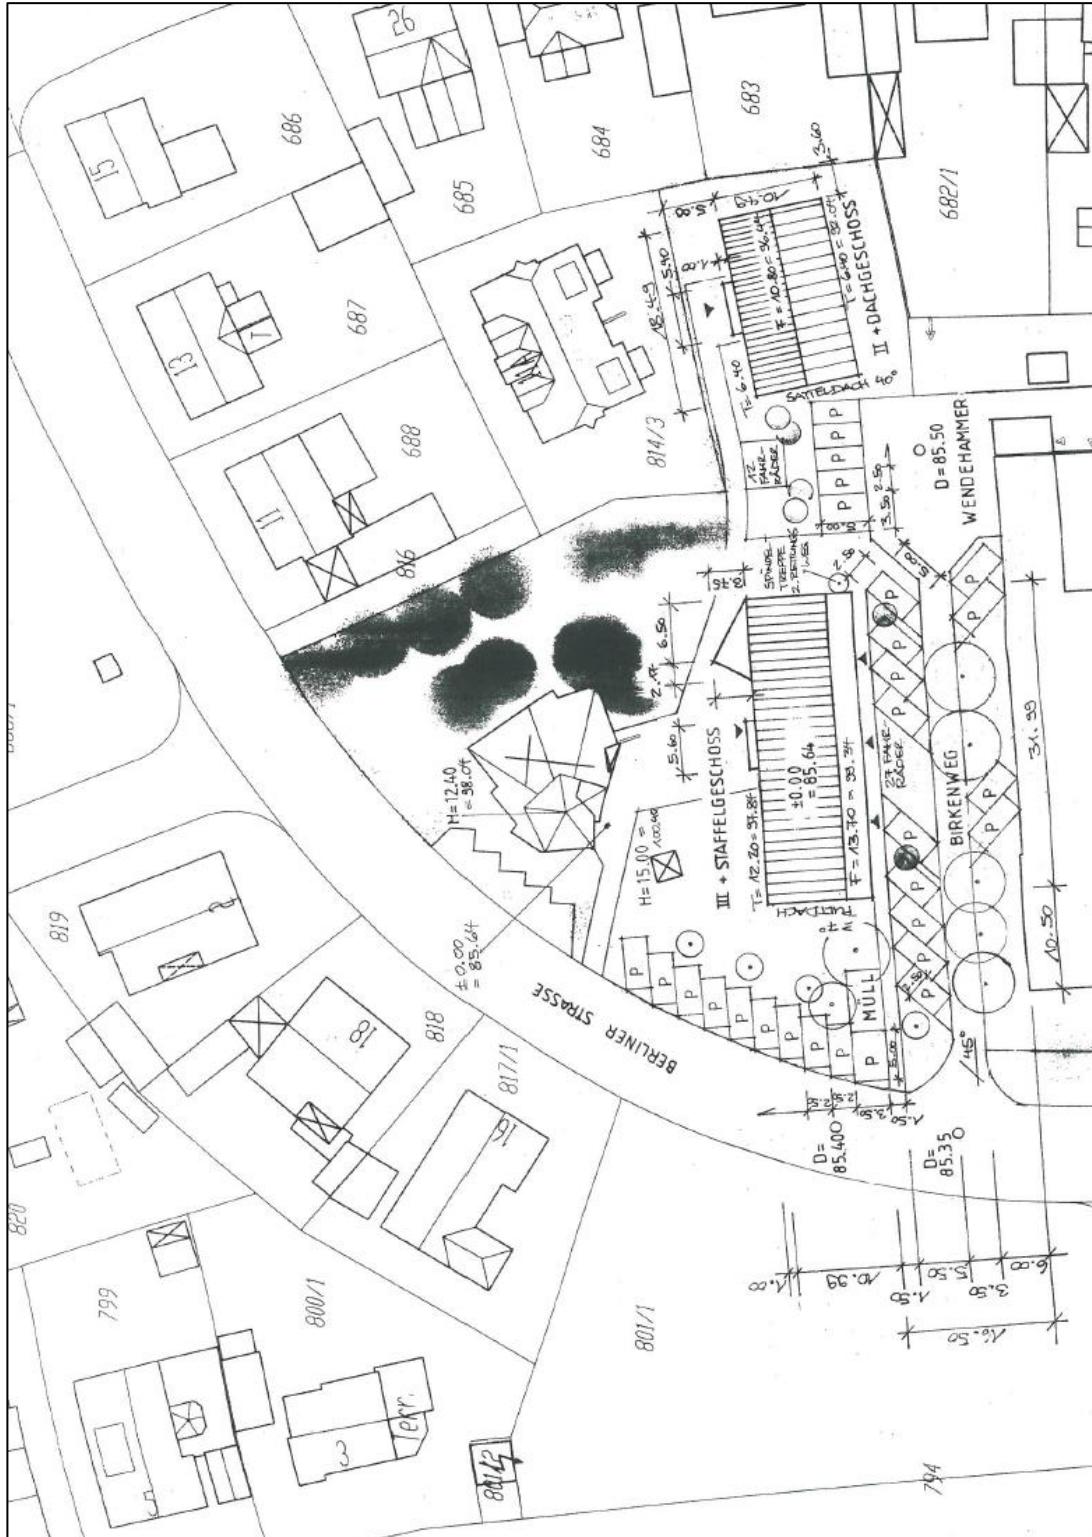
Vorhaben- und Erschließungsplan „Berliner Straße“ (Michael Müller, Freier Architekt, Wiesbaden, 27.07.2018)
